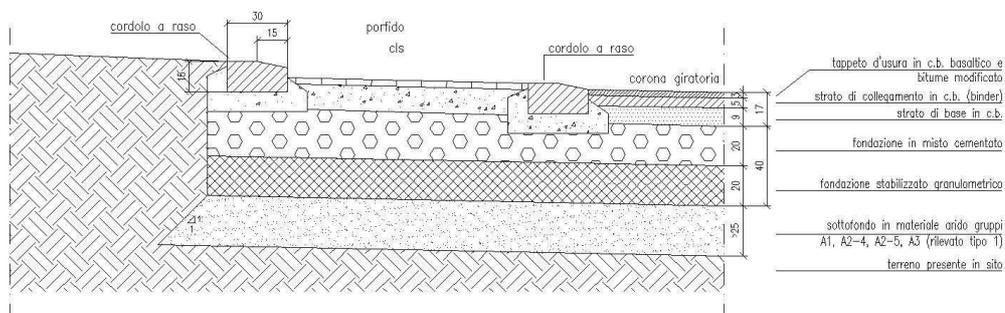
Particolare costruttivo pavimentazione/cordolo sormontabile
